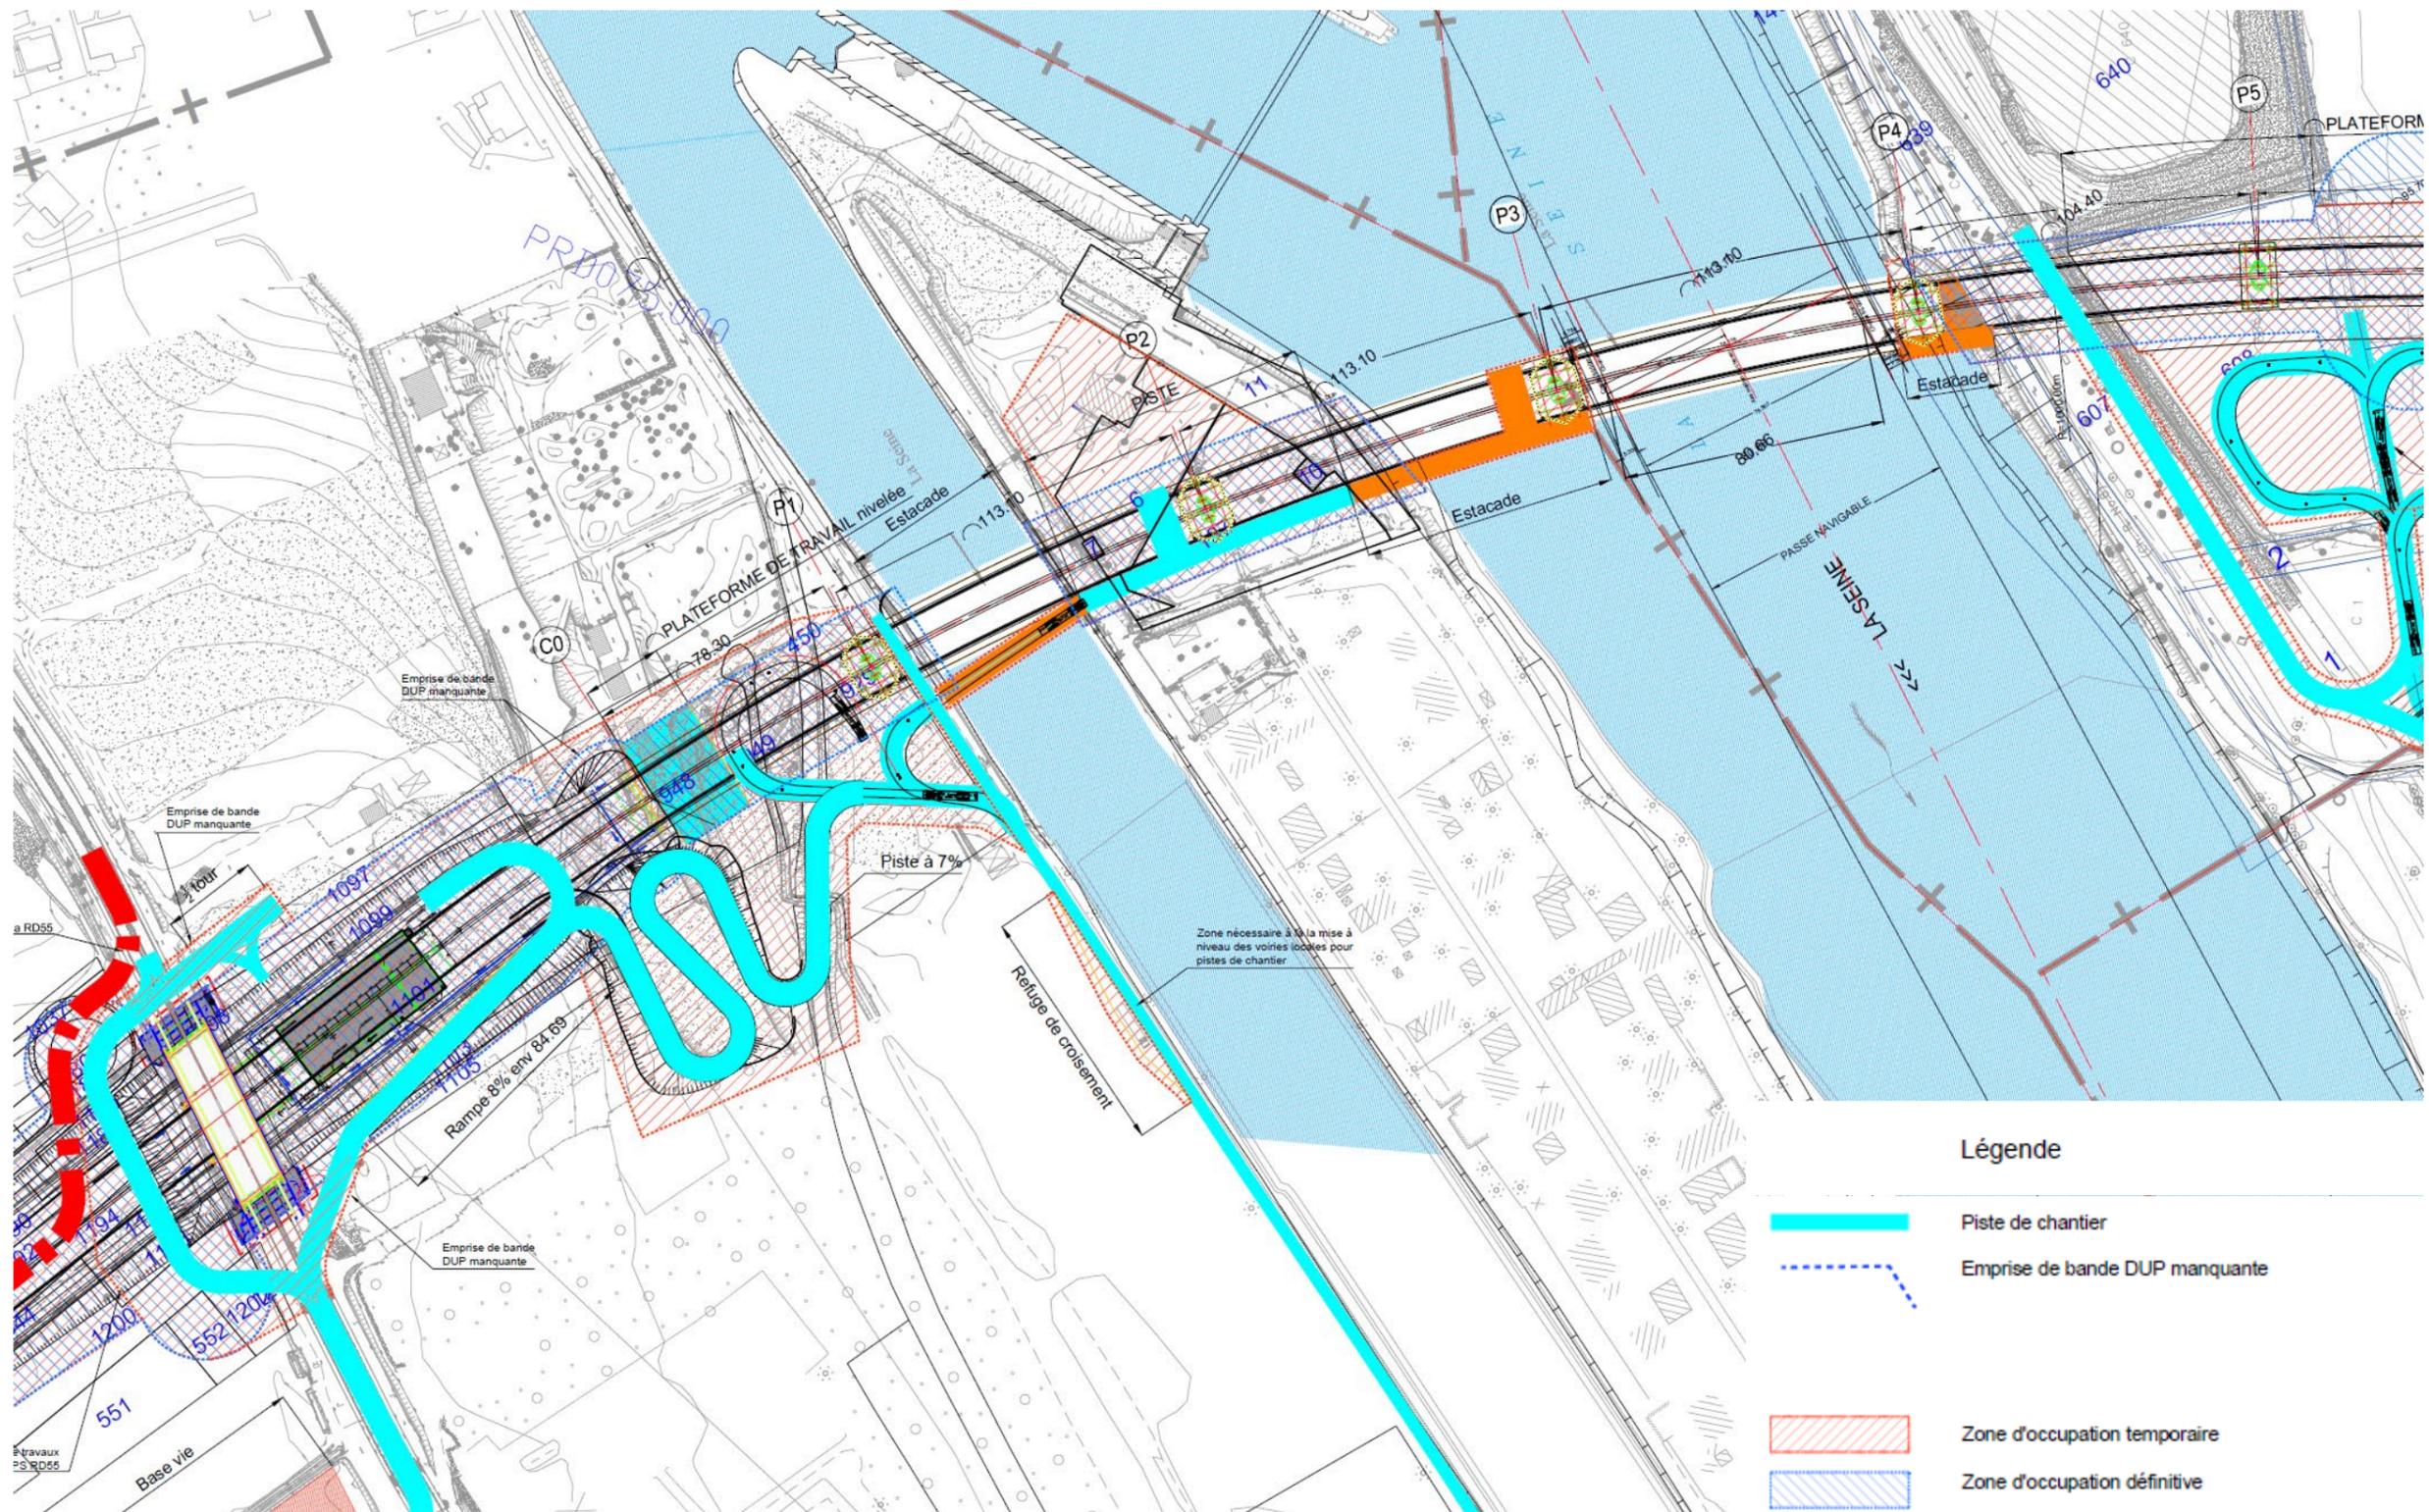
Vue en plan des installations de chantier du viaduc au droit de l'île de la Dérivation et du boisement des Garennes (source : Ingerop)
